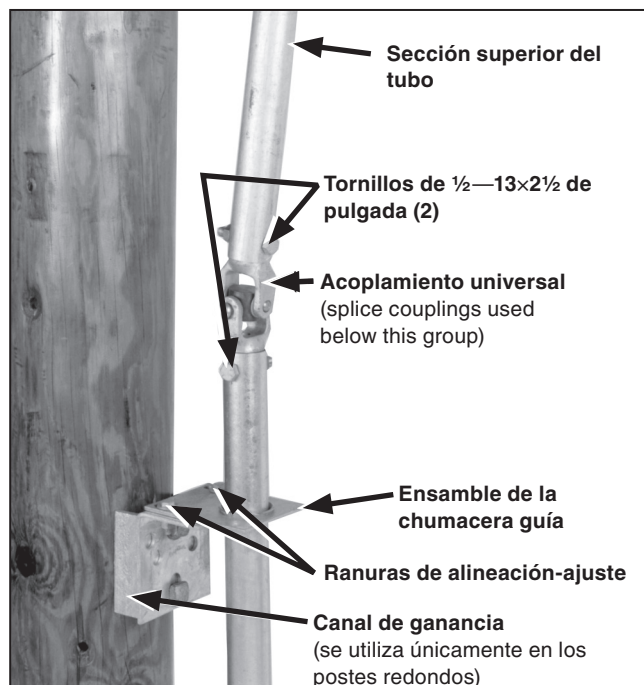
Ensamble de la chumacera guía y acoplamiento universal (posición superior).
